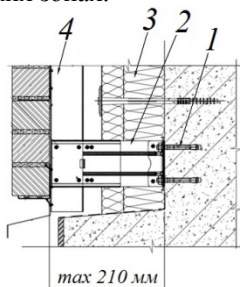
Система каркасного крепления лицевой кладки: 1 – анкер; 2 – кронштейн; 3 – теплоизоляция; 4 – вертикальная направляющая.
